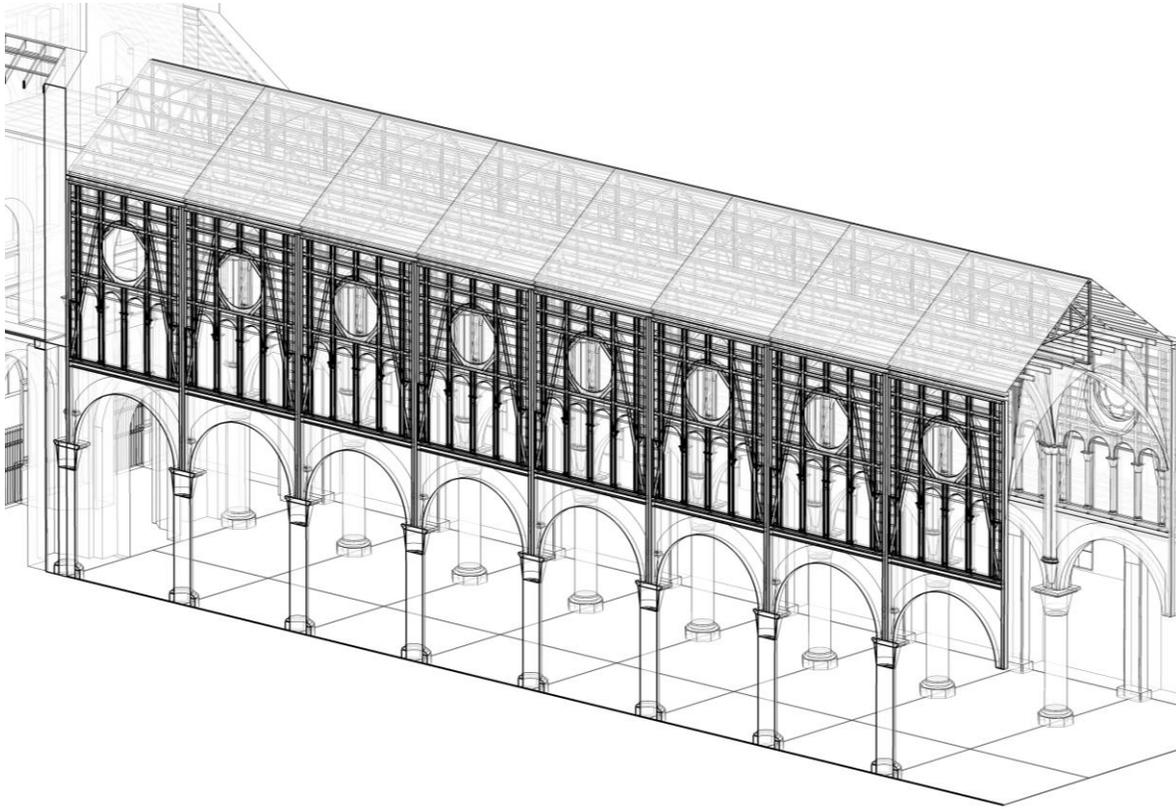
Esquema con piezas de tabiquería de madera con reemplazo puntual y aplicación de hidropelente. Elab propia.
